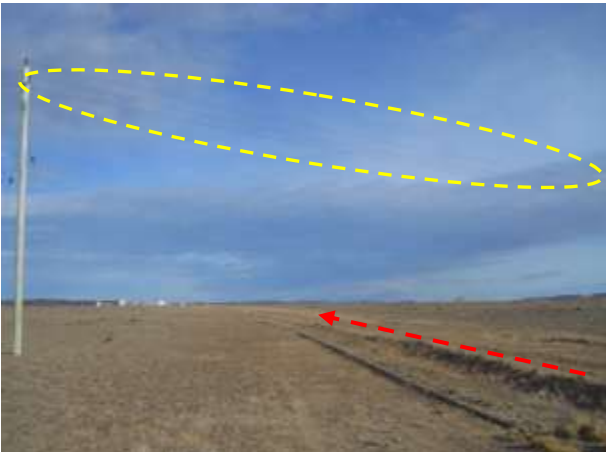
Emplazamiento de oleoducto por picada. Se observa cruce con línea eléctrica (amarillo). Foto en dirección SO.
